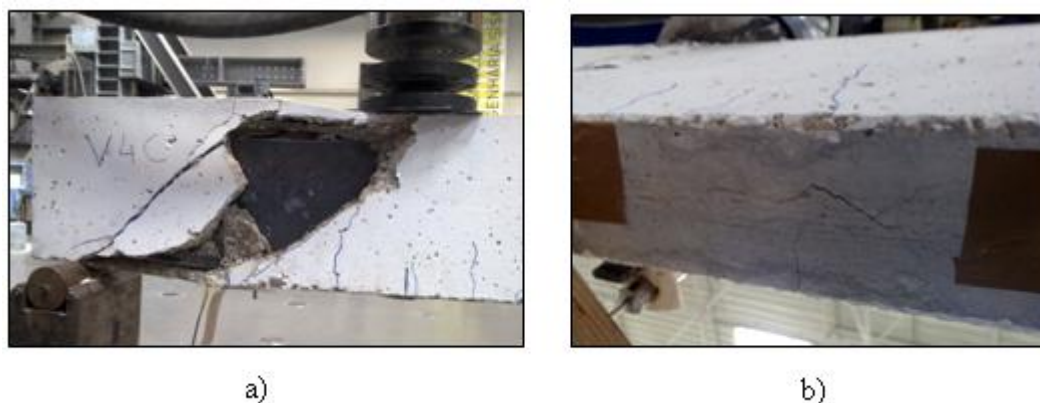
Viga V4: a) Chapa deformada; b) Face inferior da viga V4
